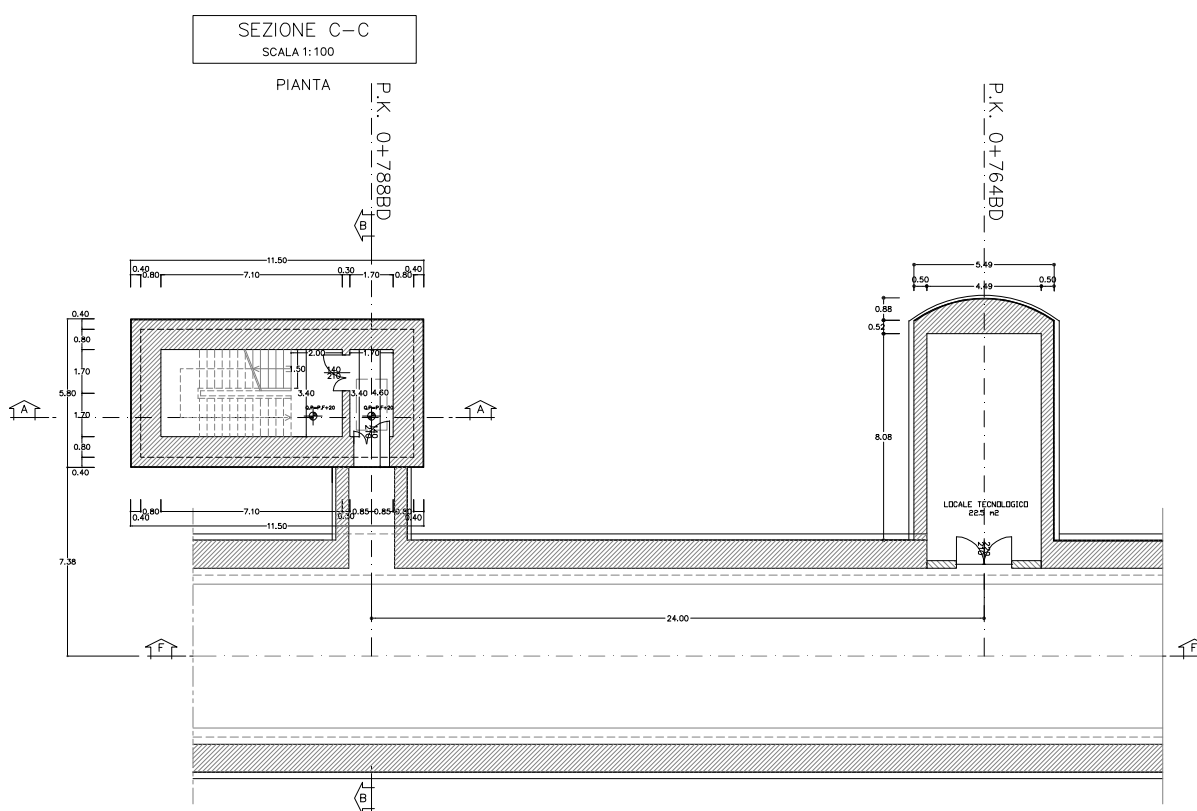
Planimetria uscite di sicurezza intermedie nelle gallerie di interconnessione
